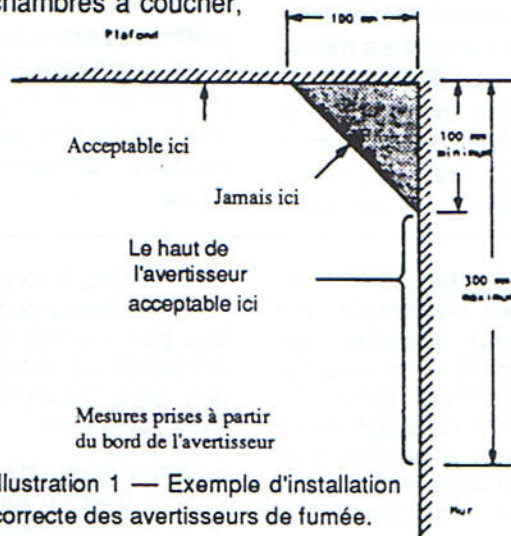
Exemple d'installation correcte des avertisseurs de fumée.
